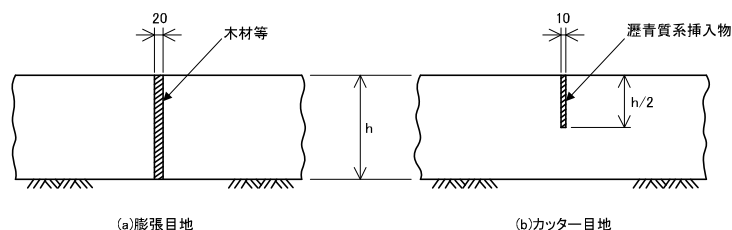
III-28 歩道、自転車等の目地 (単位：mm)
